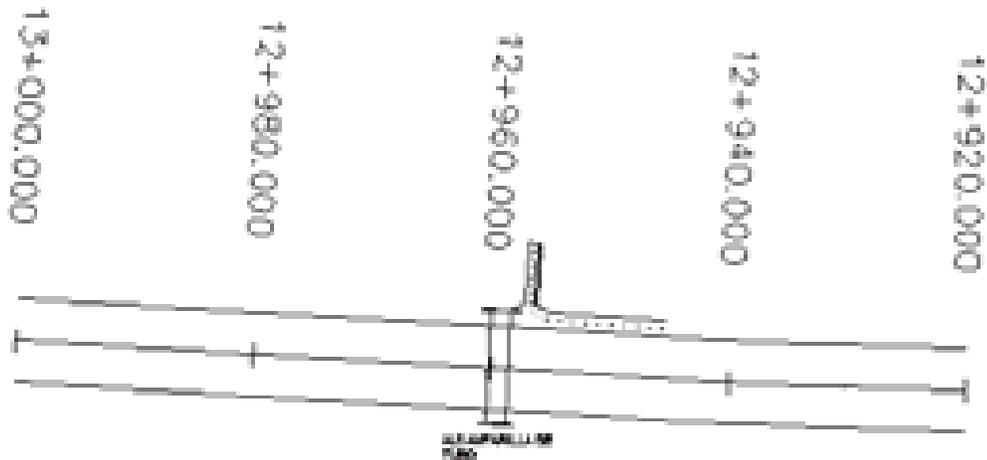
Localización del lavadero en el kilómetro 12+957.
